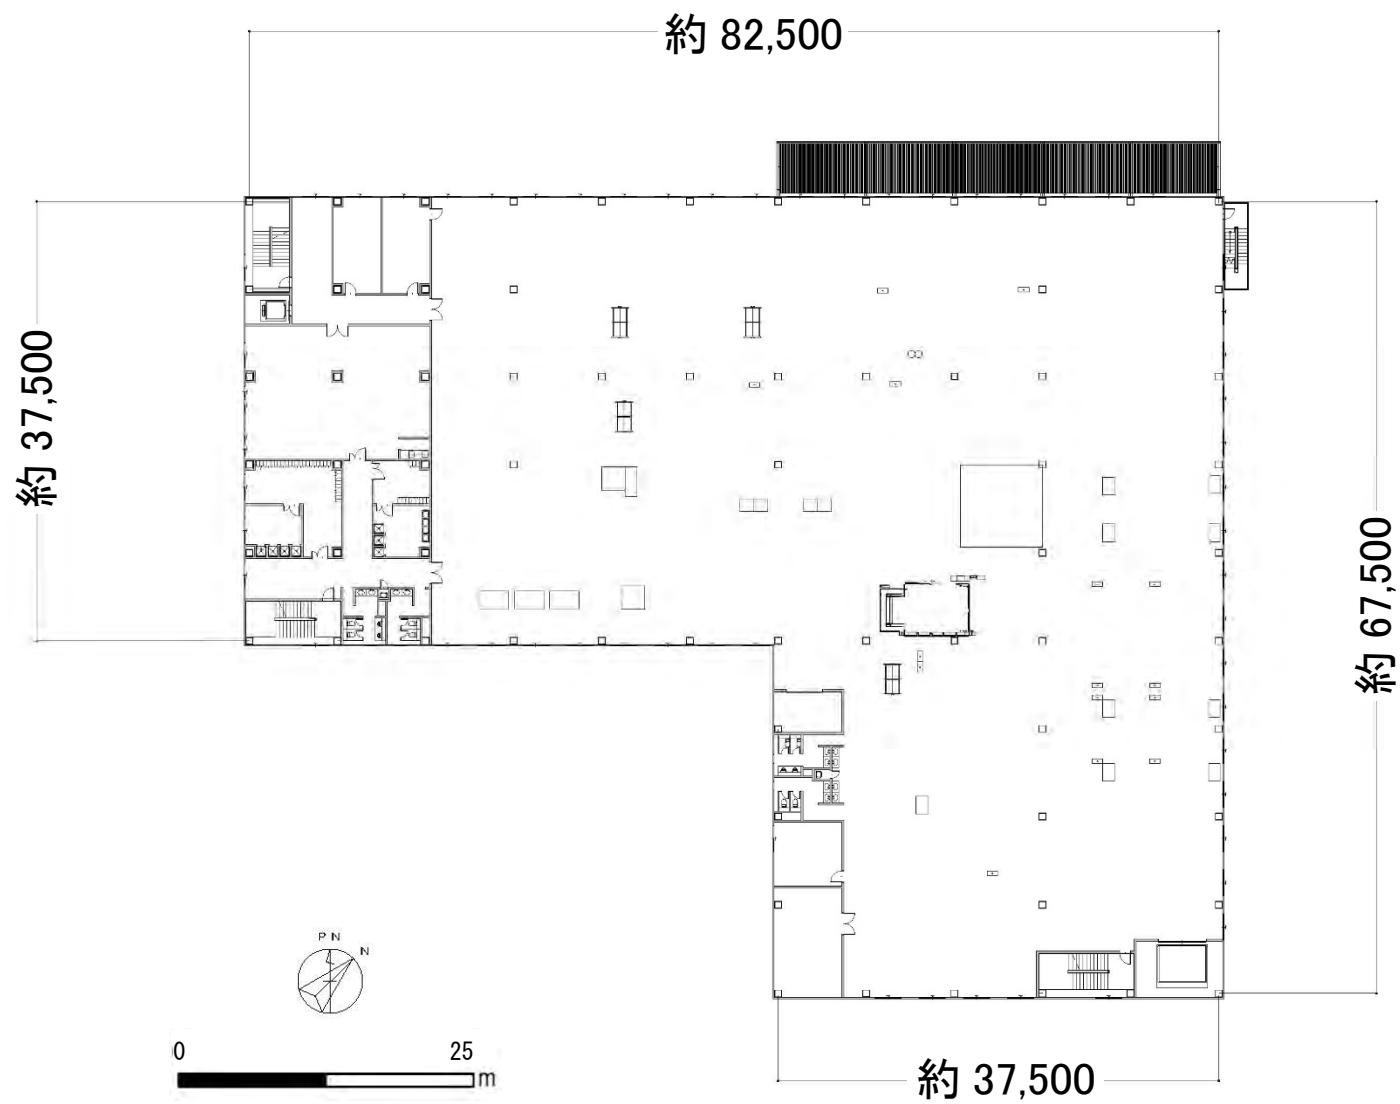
(3) 計画建物平面図 (3 階): 単位 mm
